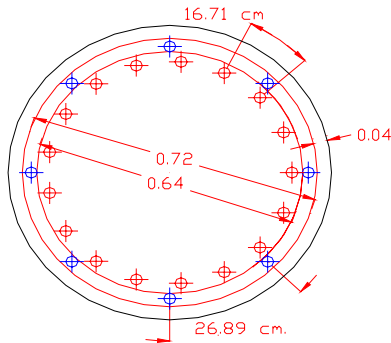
CUANTIA DE PILAR EN VIADUCTO PREFABRICADO
